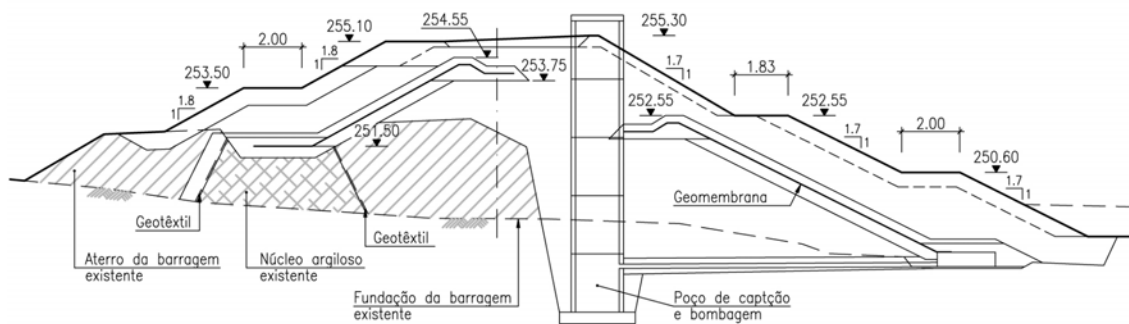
Perfil transversal tipo do alteamento da barragem de Monte Branco na parte central
